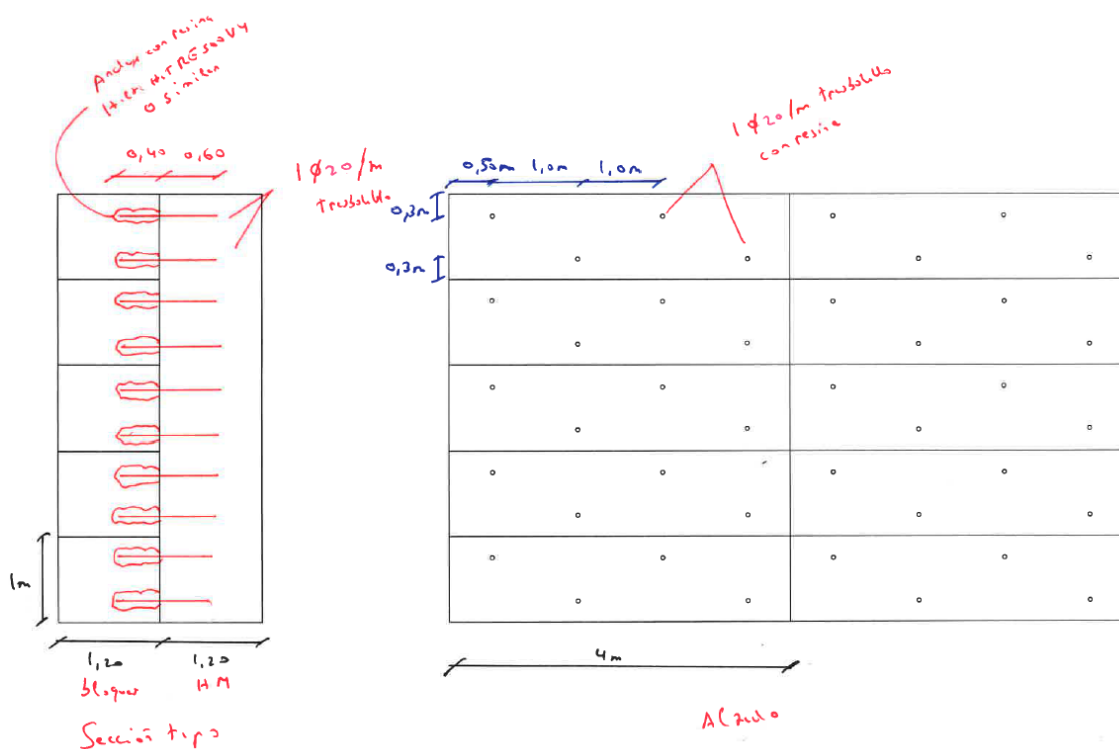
Detalle de la unión del muro de piezas prefabricadas con el muro de hormigón en masa
